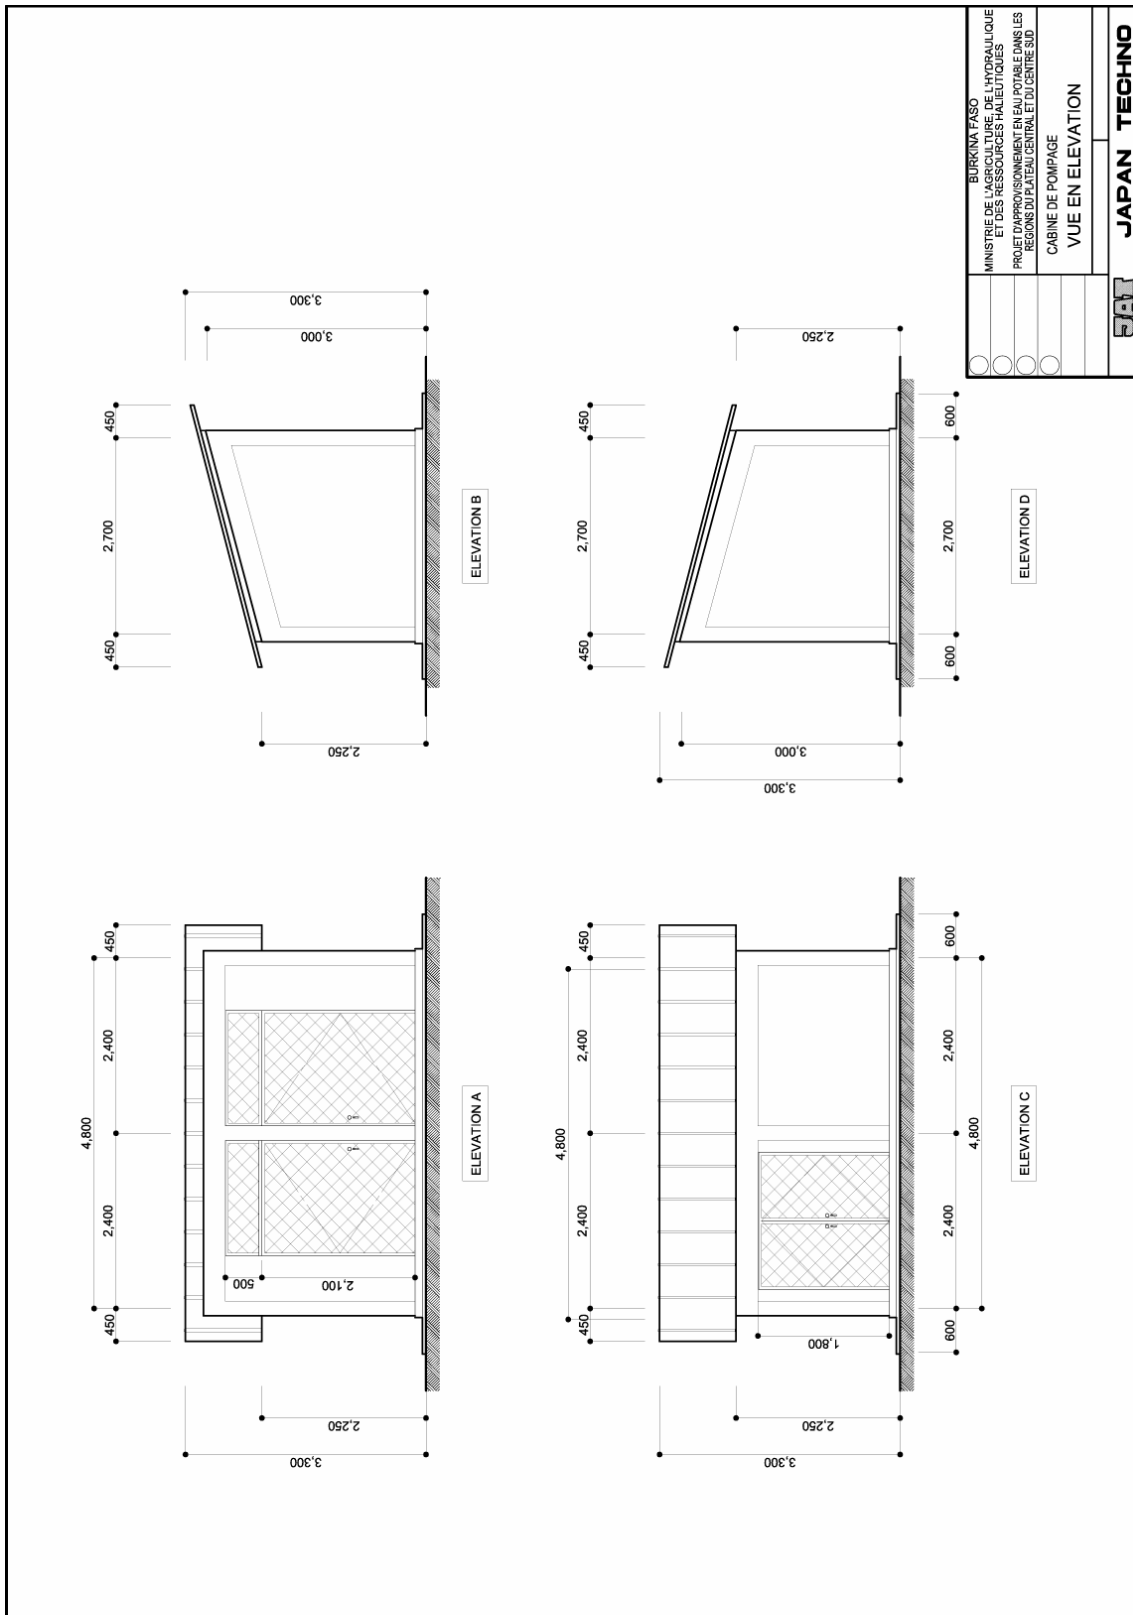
Plan de la cabine de machinerie d'un AEPS
